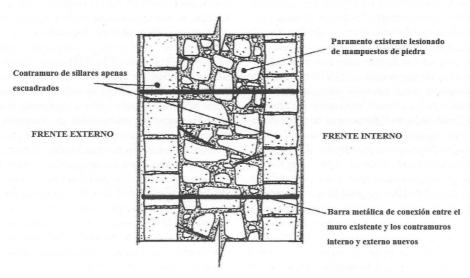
Consolidación de un muro con barras de hierro (Campisi y Fatta 2009)
